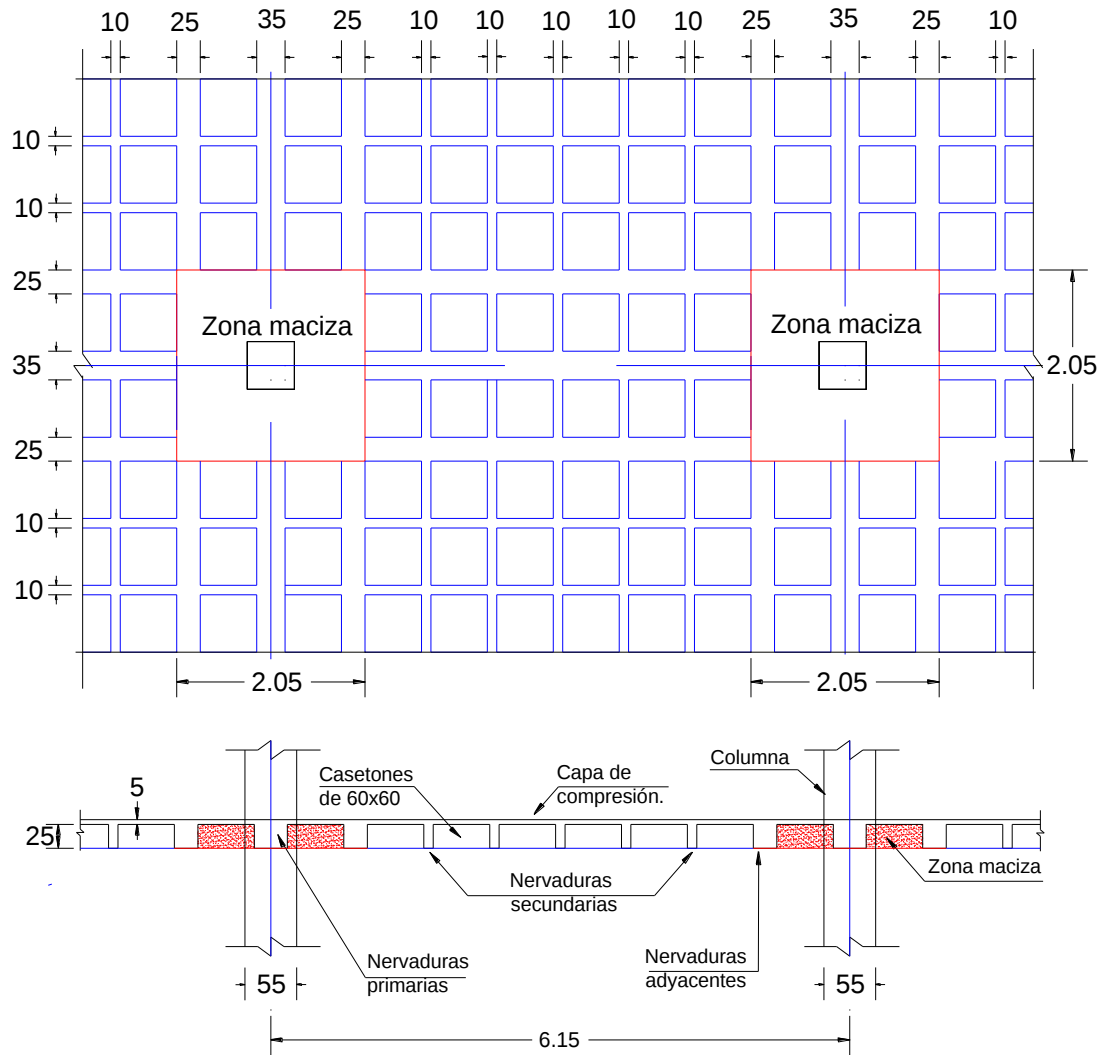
Dimensiones de los elementos de la losa plana aligerada.
